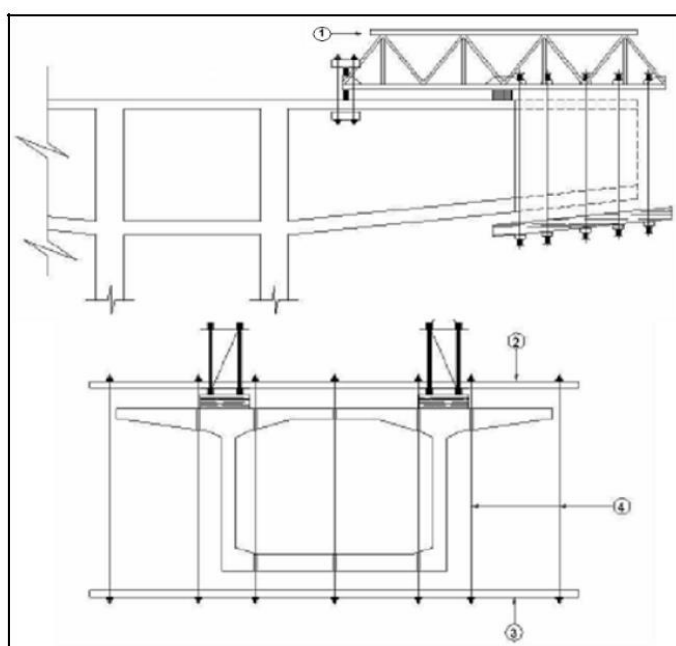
Escoramento superior para balanço sucessivo – tipo treliçado 1) viga principal, formado por treliças moduladas; 2) vigamento transversal superior; 3) vigamento transversal inferior; 4) tirantes reguláveis de suspensão. (SOMAQ, 2015)
